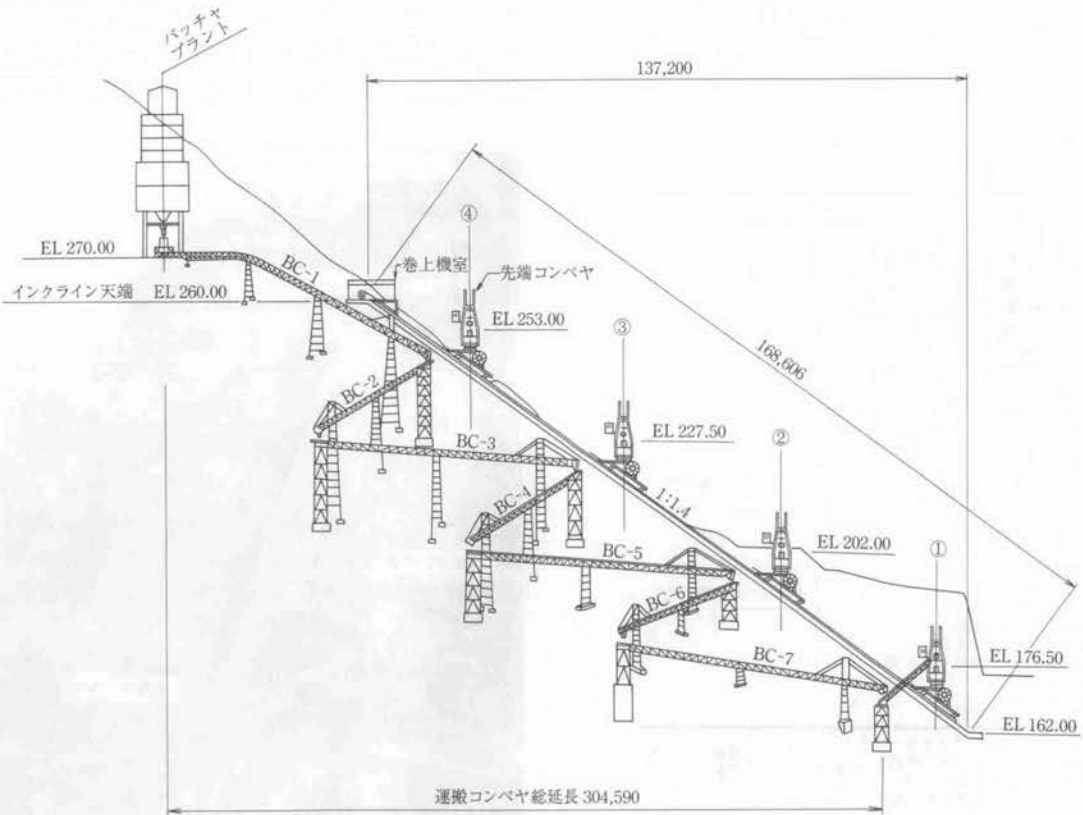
(2) コンクリート運搬ベルトコンベヤ概要図
